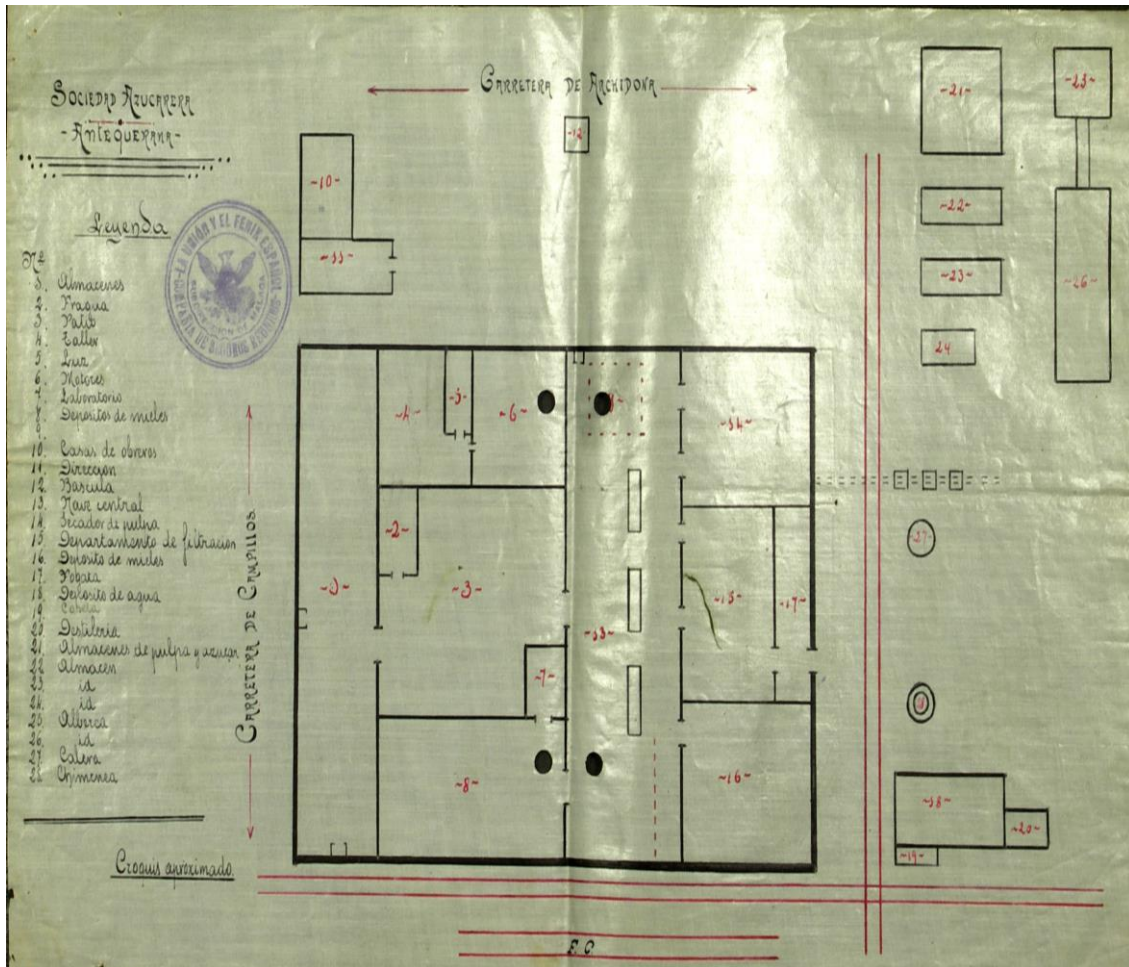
Plano de la Planta General de la azucarera San José (Antequera). Fuente: AMA
